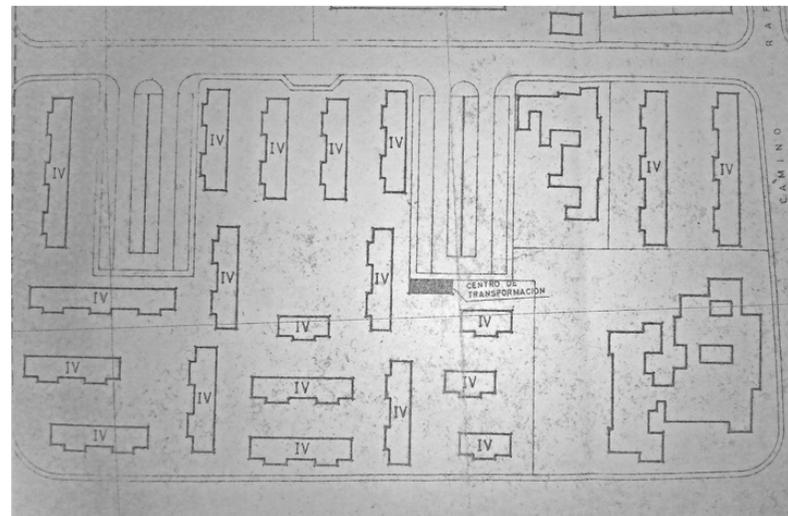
Fragmento del Plano de Ordenación del Plan Parcial de Rafalafena, correspondiente al Sector I, con la disposición y tipología definitiva de los bloques en las parcelas.
